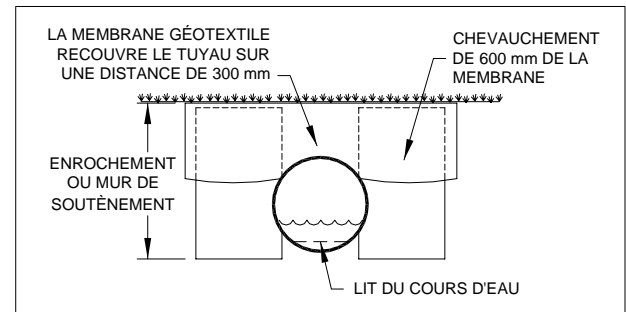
Installation de membranes géotextiles autour d'un tuyau
